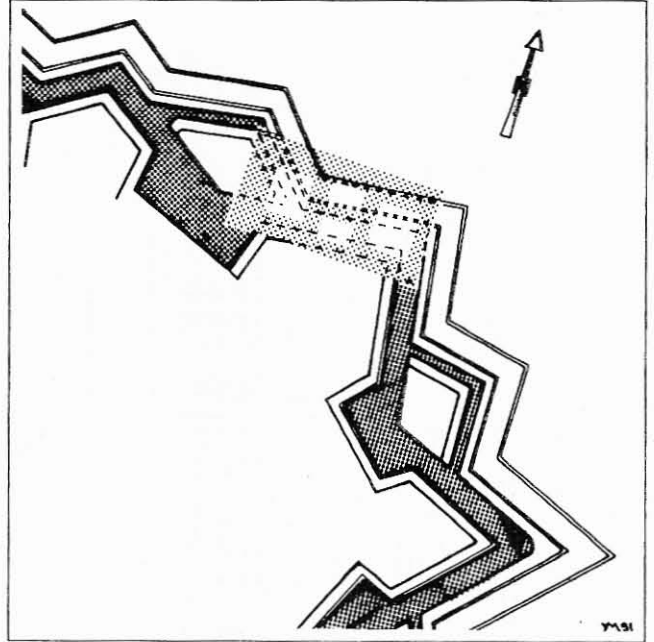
Essai de positionnement des casernes sur le plan de 1629 (échelle environ 1/500e).
